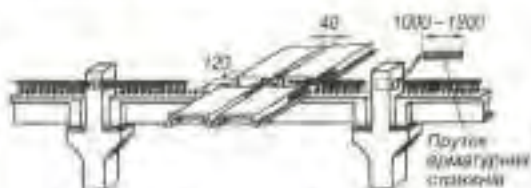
З'єднання збірно-монолітної конструкції каркаса будівлі
